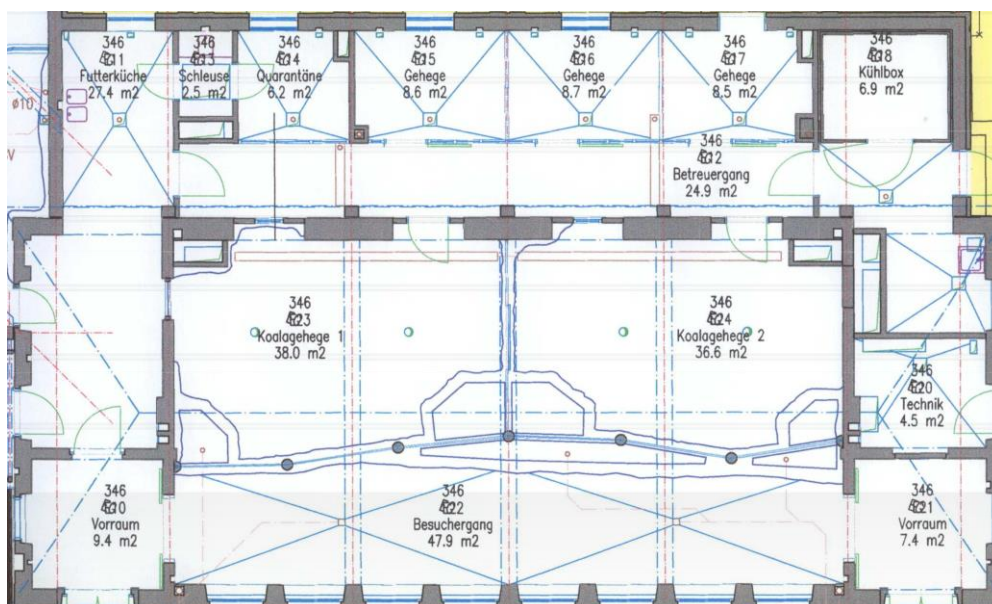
Plan des Koalahauses mit Gehegen, Pflegerbereich und Besucherraum
